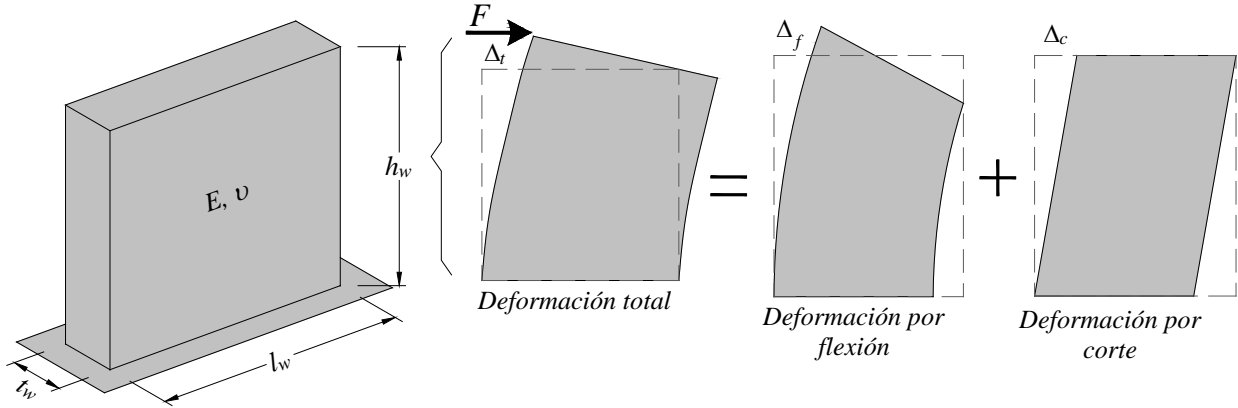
Deformación de un muro en voladizo bajo fuerza lateral (Neuenhofer, 2006)¹⁵
